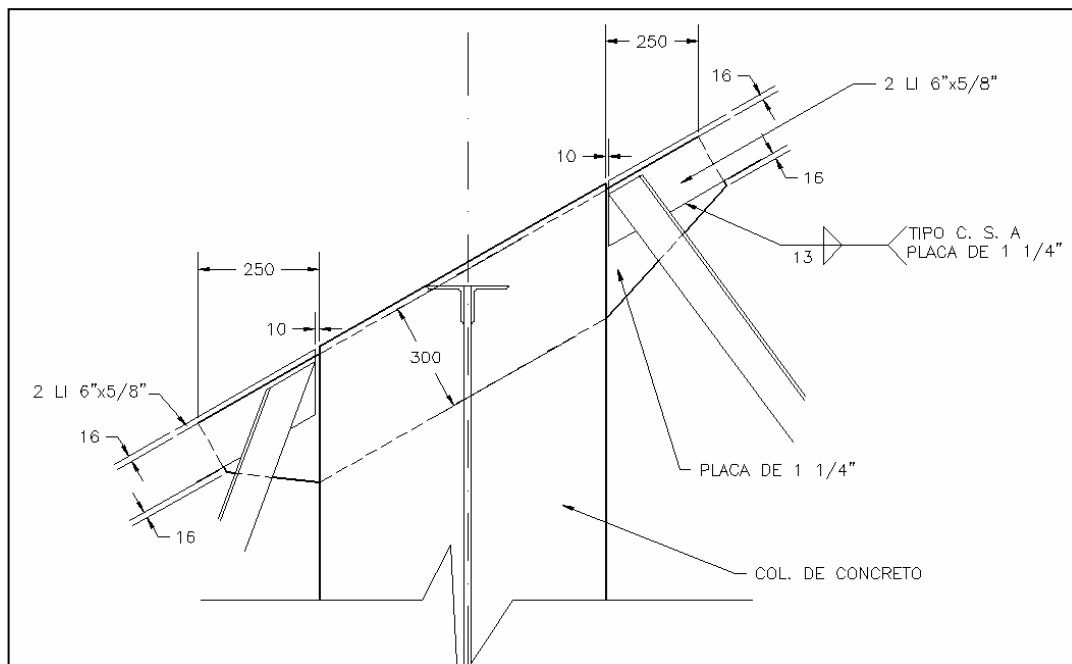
Conexión tipo (elevación) para dar continuidad a la estructura metálica y estructura de concreto, consistió en colocar una placa que atraviesa la sección de concreto y sobresale para recibir las cuerdas de las armaduras metálicas, con la sección igual al área del ángulo de mayor sección.
